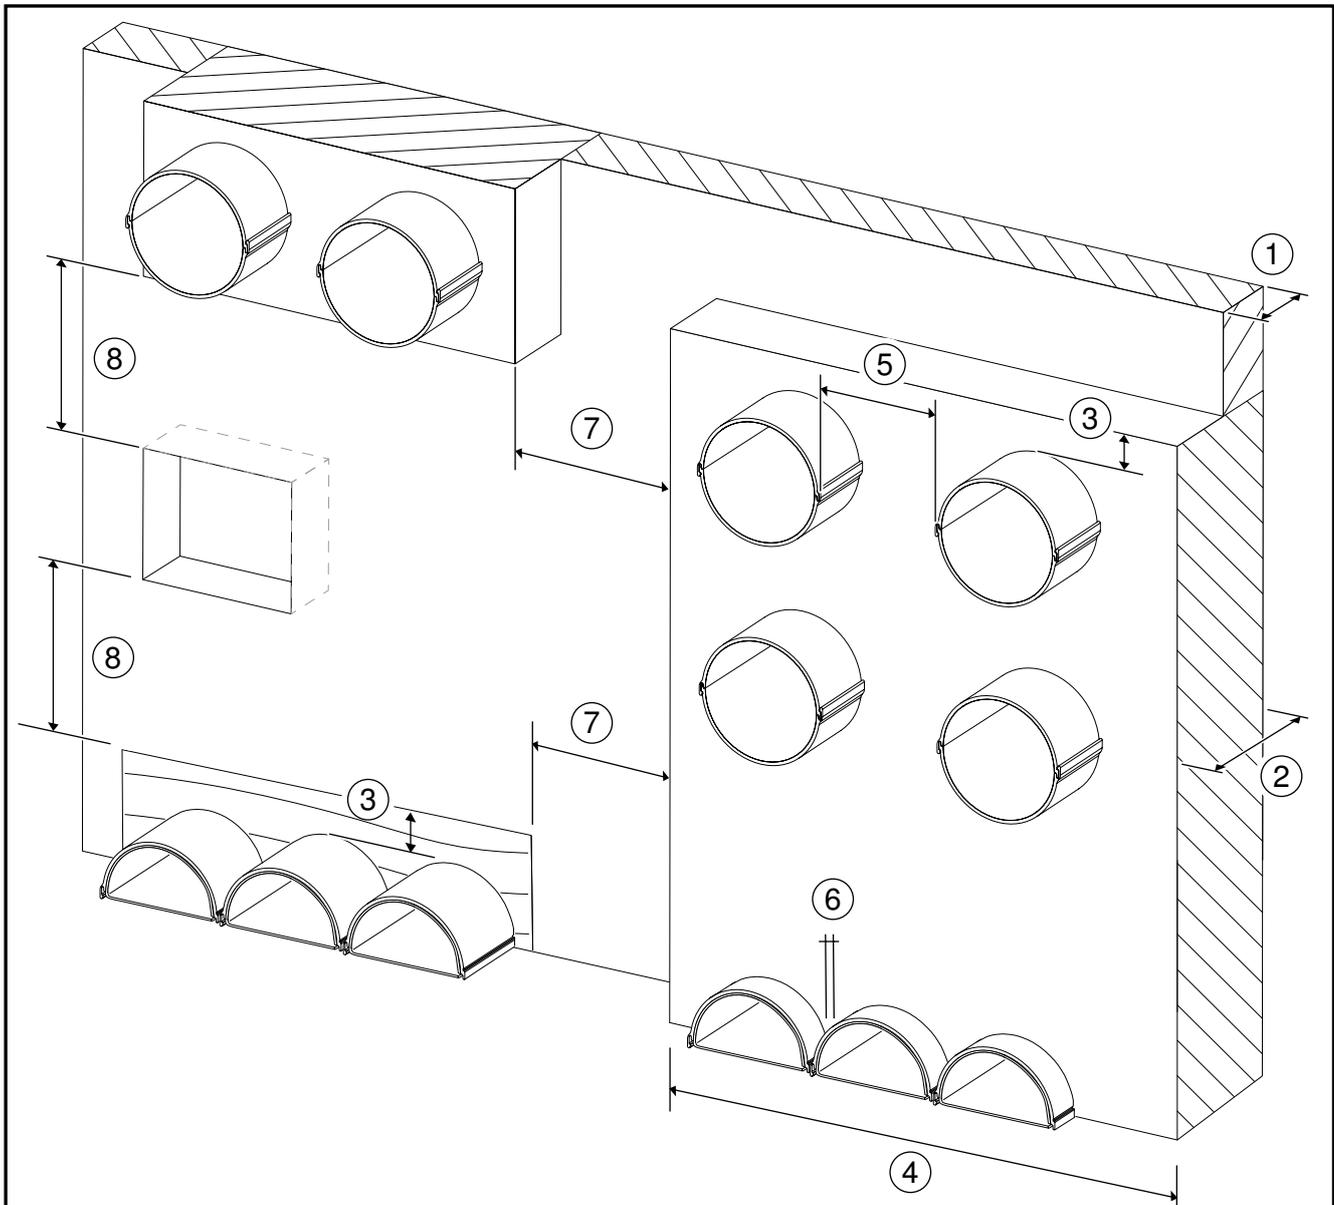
Abstände bei Einbau in Bauteilöffnung
